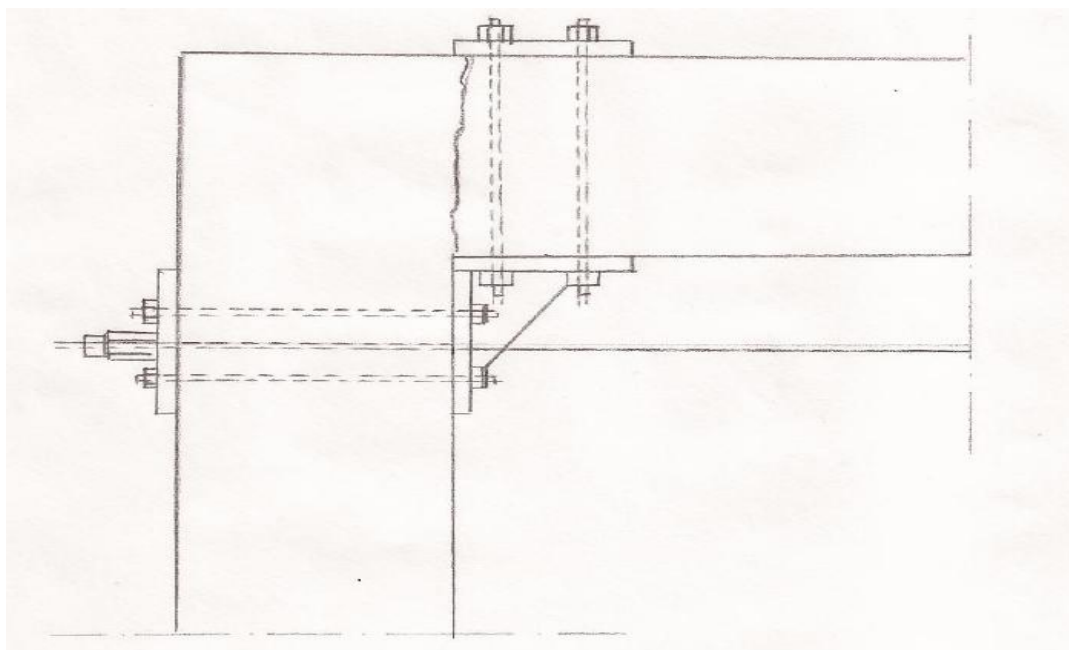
Esquema de aplicação de tirante com cantoneira.
